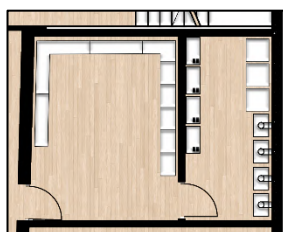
Planta en sección – Almacén y cuarto de máquinas
